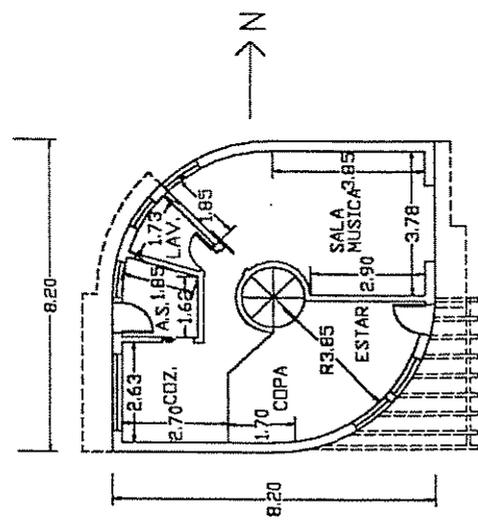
Planta baixa da Edificação 03. Fonte: Elaboração própria.
